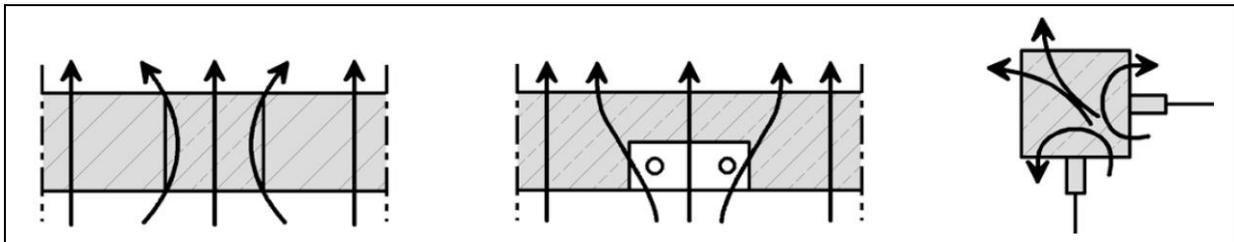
Beispiele für Wärmebrücken; links: Stahlbetonstütze in Mauerwerkswand, Mitte: Installationschacht in Außenwand, rechts: Stahlbetonstütze mit Fensterschluss beidseitig [8]
